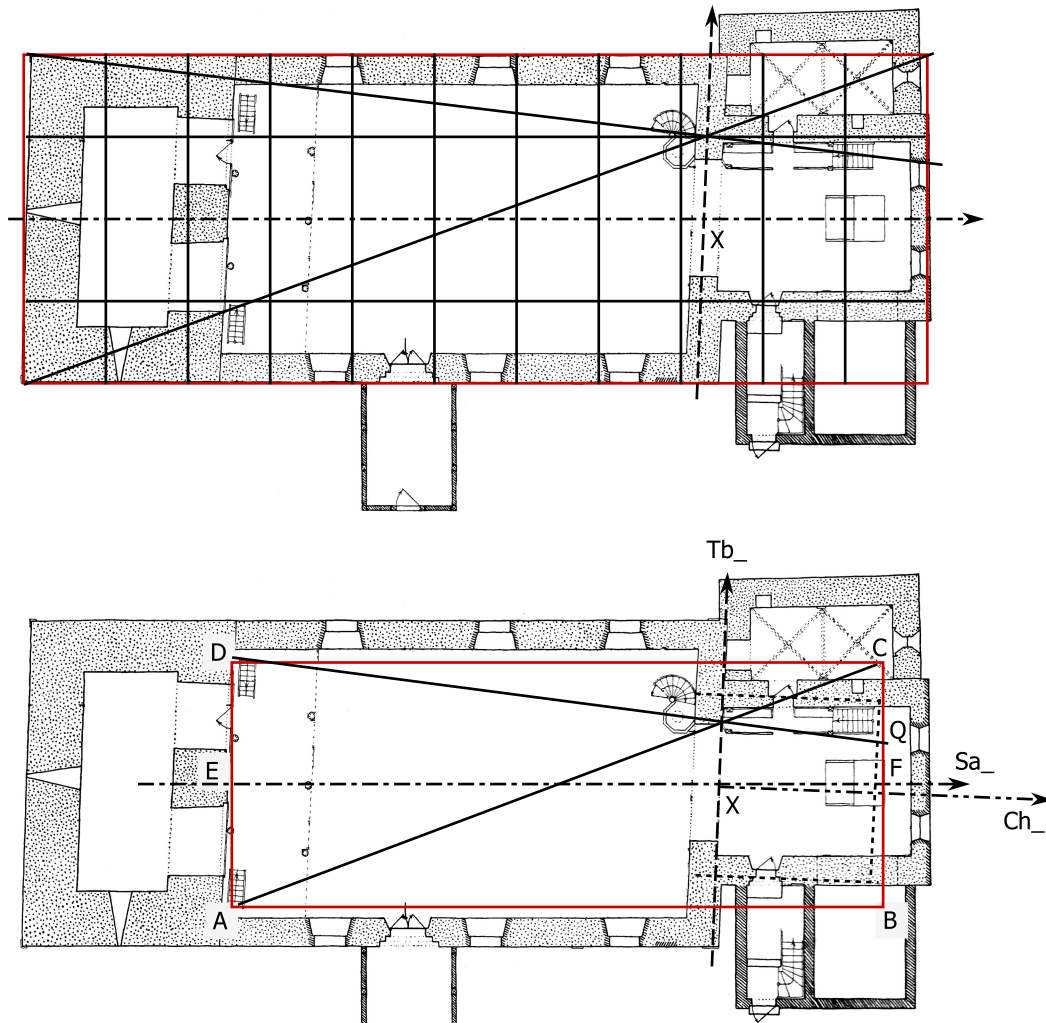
Grundriß der Krüden Kirche im Maßstab 1:300.
